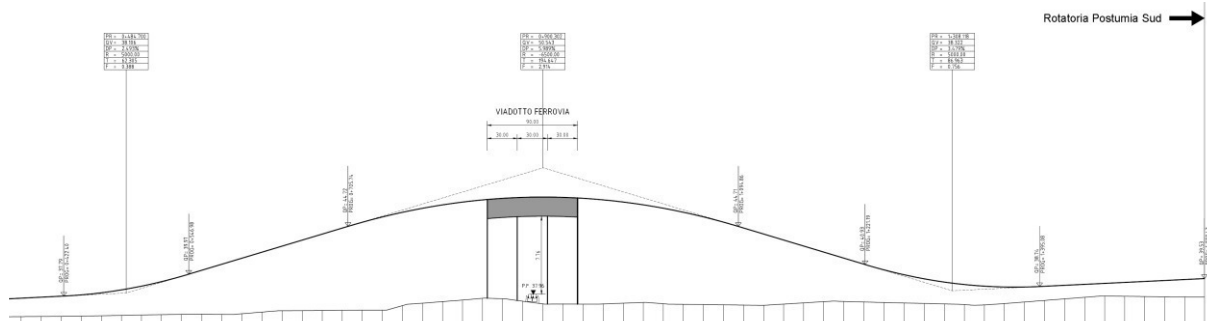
Profilo longitudinale asse principale - Tratto 1 con scavalco ferrovia Vicenza-Treviso
